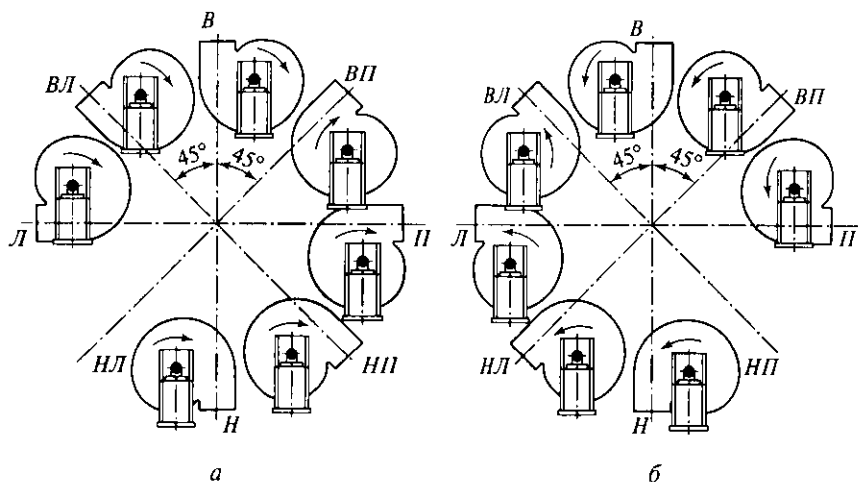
Стандартные положения корпусов вентиляторов общепромышленного назначения с вращением рабочего колеса по часовой стрелке (а) и против часовой стрелки (б). Буквами обозначено расположение входного патрубка — верхнее, нижнее, левое, правое
